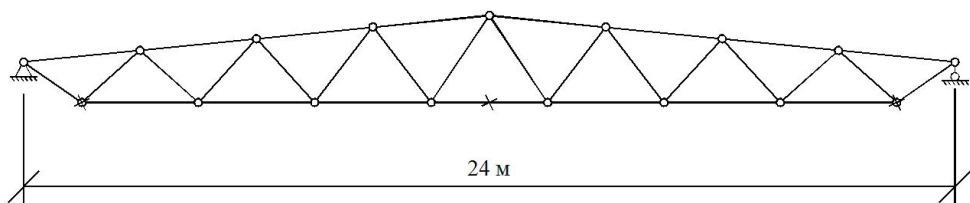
Схема крепления связей по нижнему поясу фермы:
